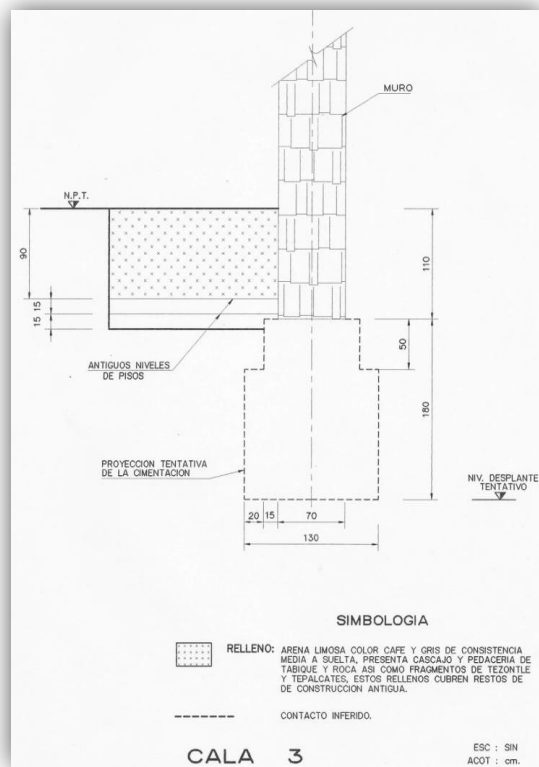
Levantamiento de la cimentación en la calca 3 [2.16].
